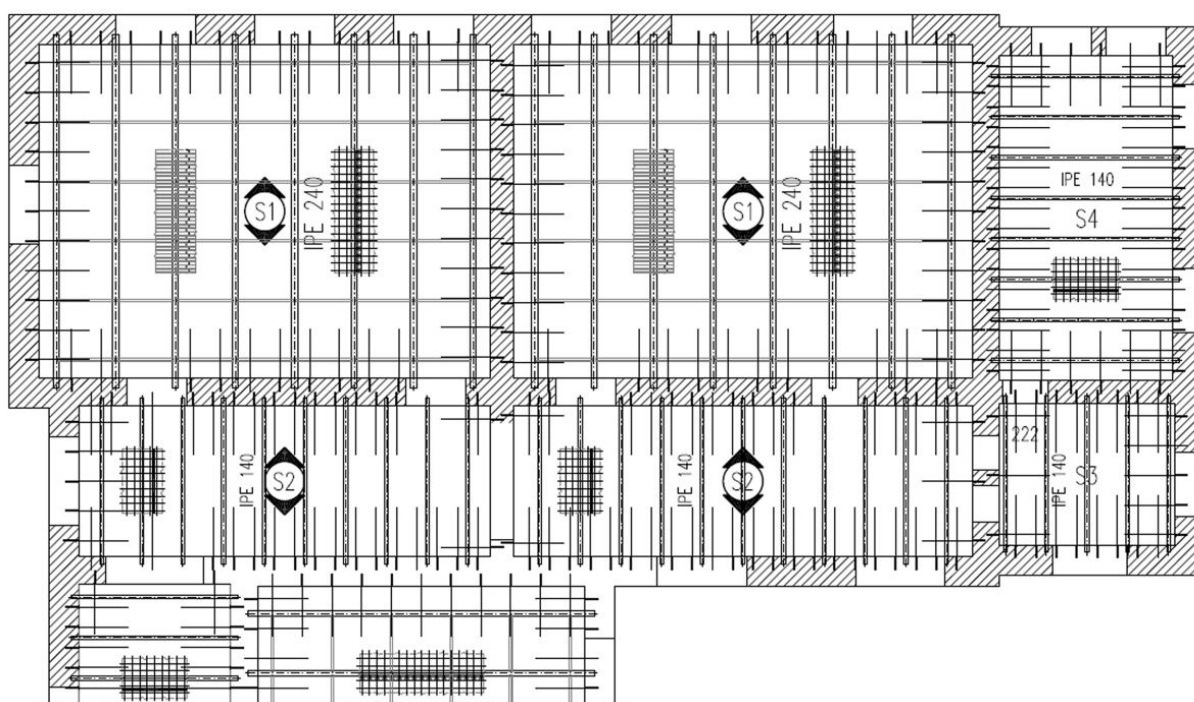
stralcio della carpenteria con indicazione planimetrica dei grip-round
